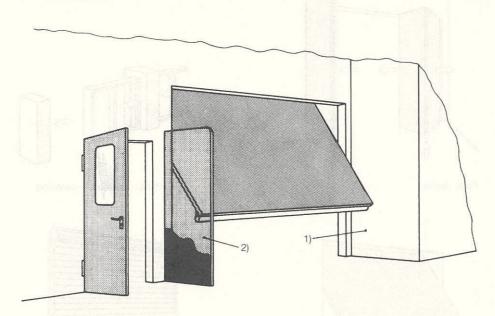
mesures de construction pour la protection des zones de coincement accessibles aux arêtes de fermeture secondaires d'une porte basculante.
